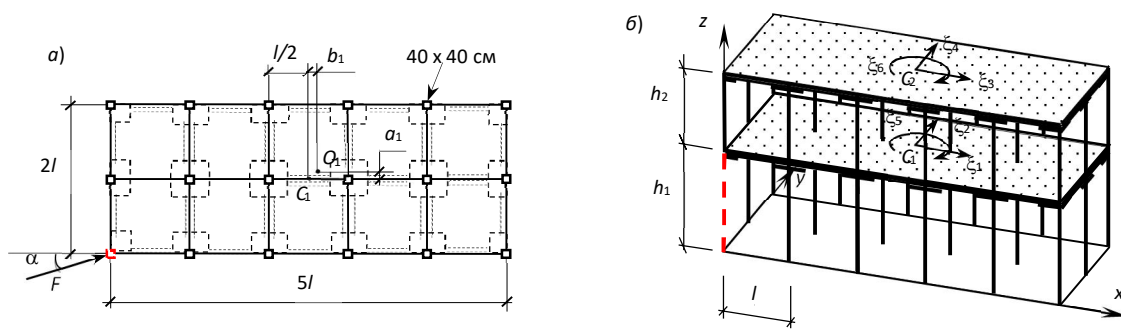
Расчетная модель 2-этажного железобетонного каркаса:
